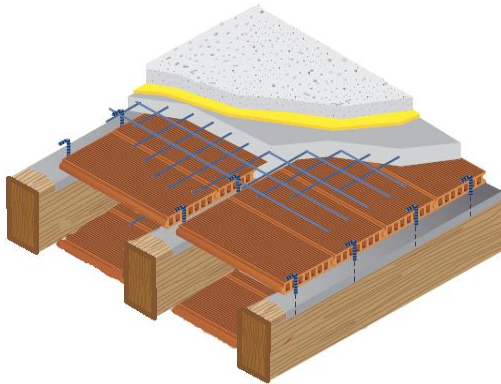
Ricostruzione di un solaio del tipo "controsoffitto alla Perret"
